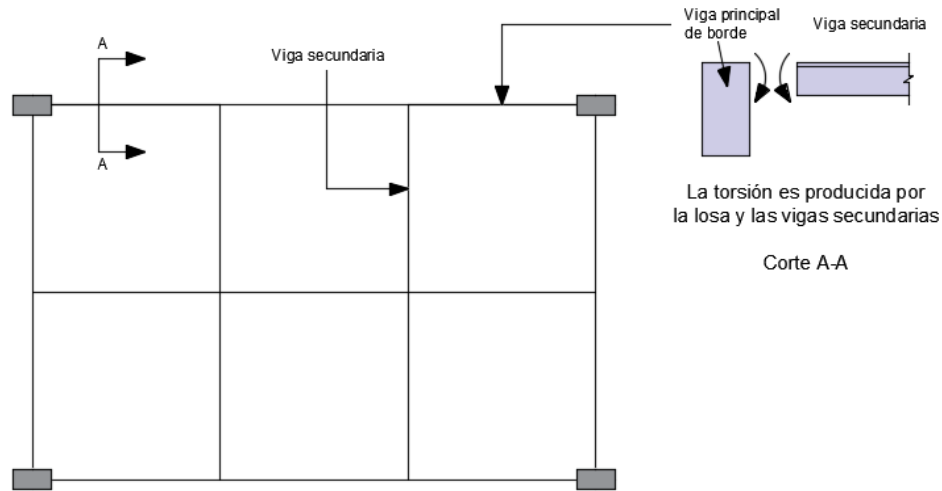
Vigas de borde en sistemas de piso, elemento estructural sujeto a torsión
